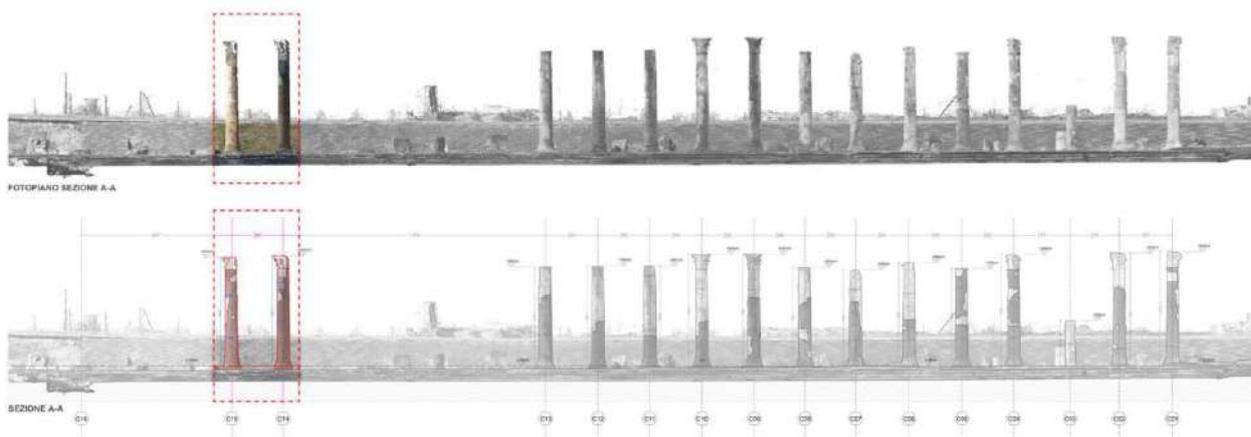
Colonne 14 e 15 coinvolte nel progetto del “Cantiere Pilota”
